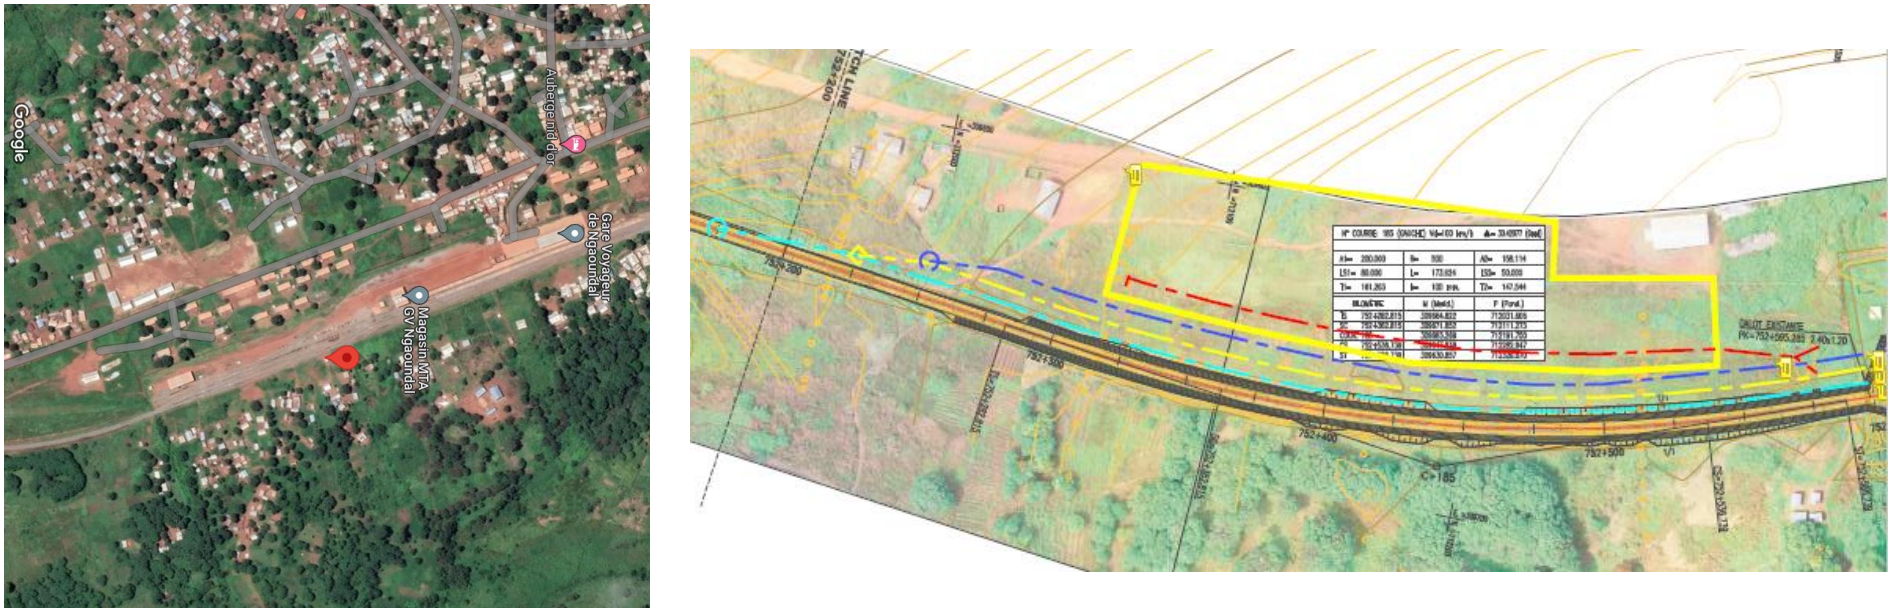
Vue aérienne et Plan de masse de la base travaux à Ngaoundal (gare)
